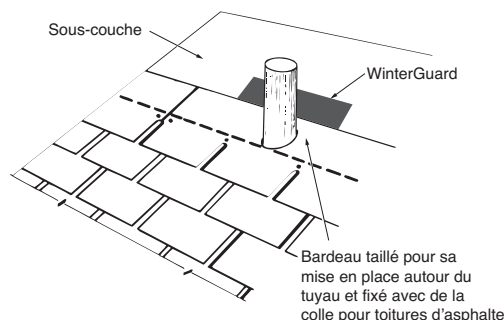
Taille du bardeau pour sa mise en place autour du tuyau de ventilation.
